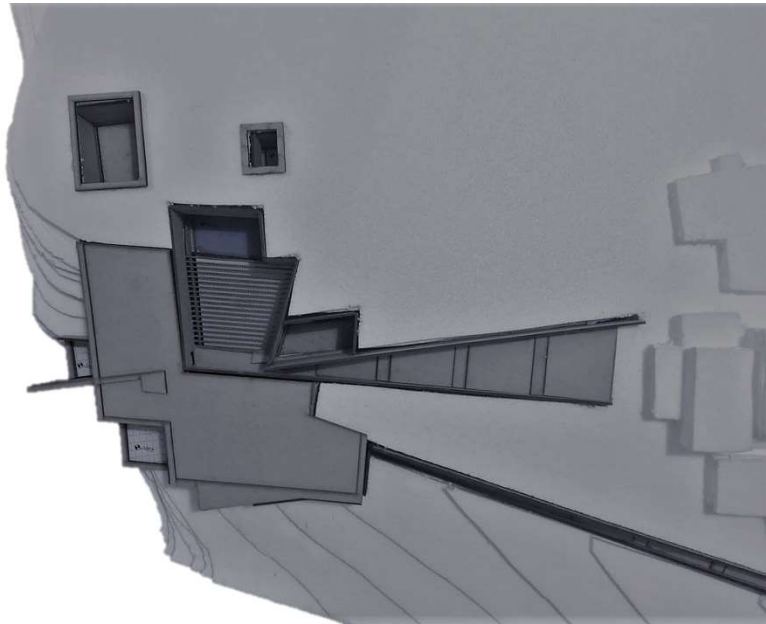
| Maquete do Edificado Proposto - Vista Superior
